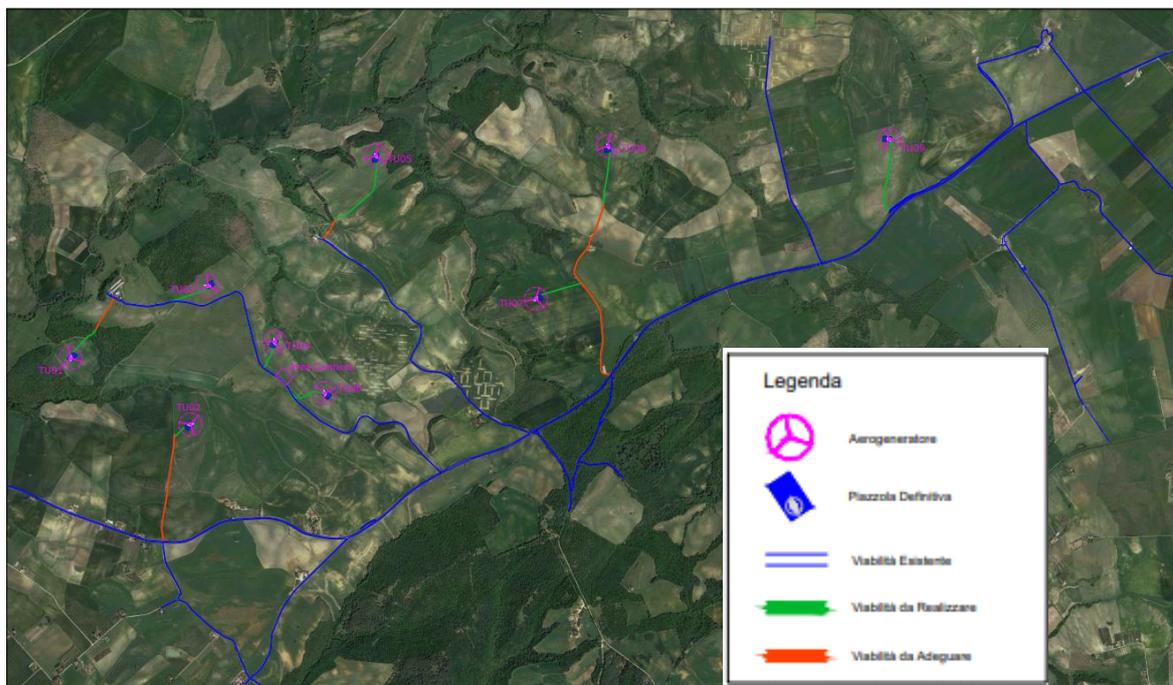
Sovrapposizione delle opere in progetto, su ortofoto.
